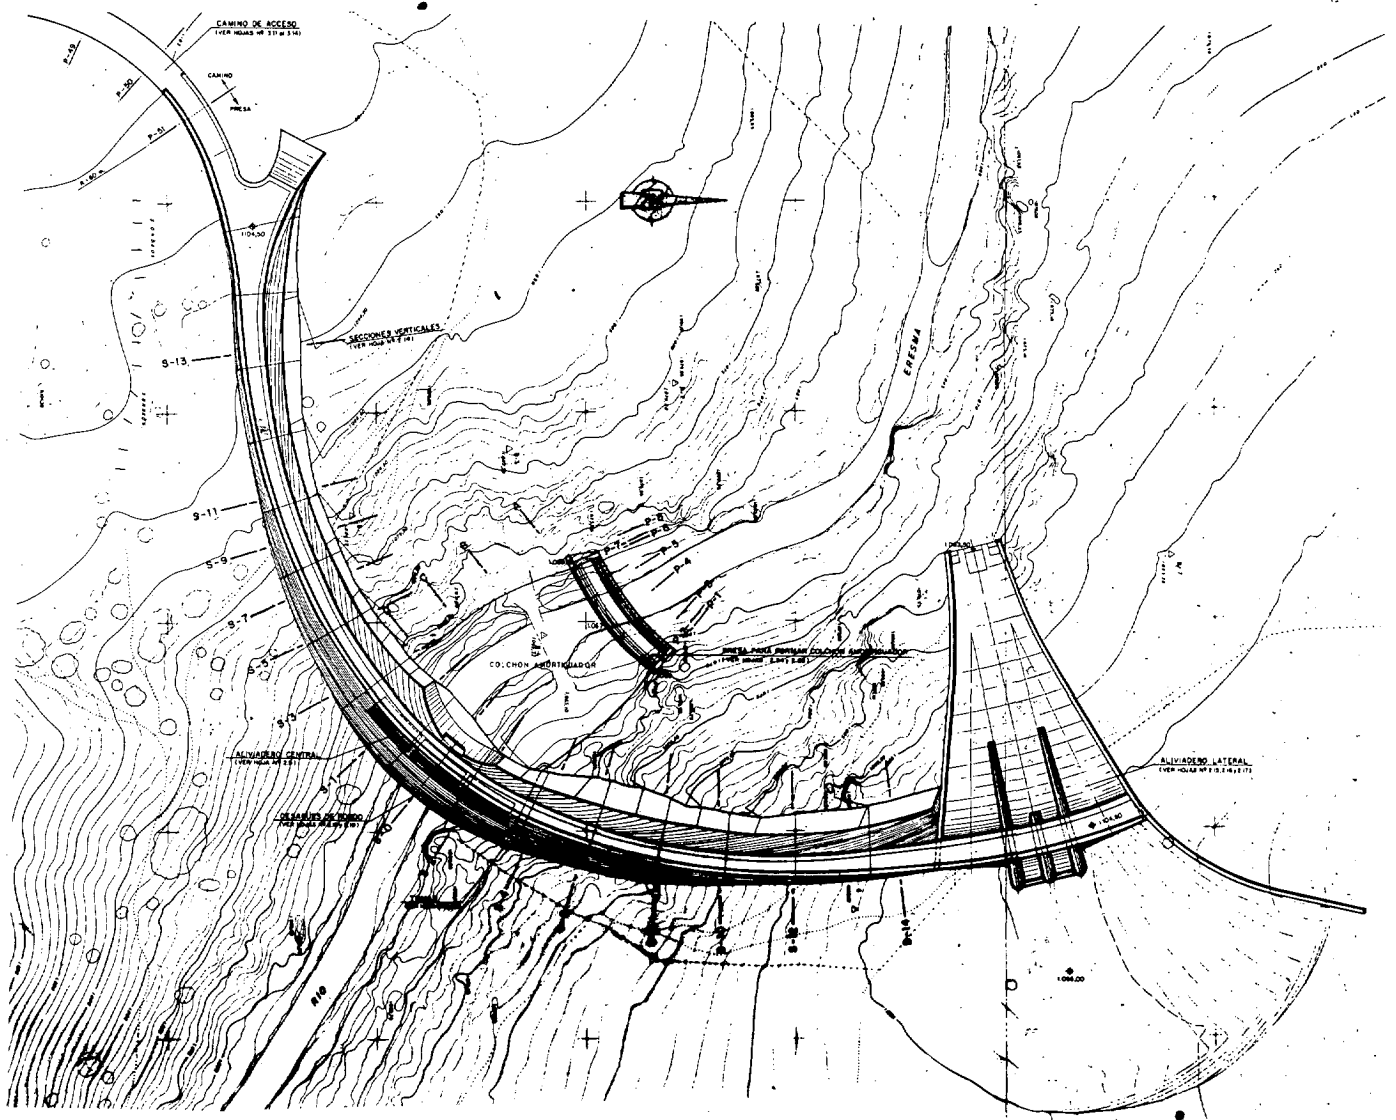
Presa del Pontón Alto. Planta General.
